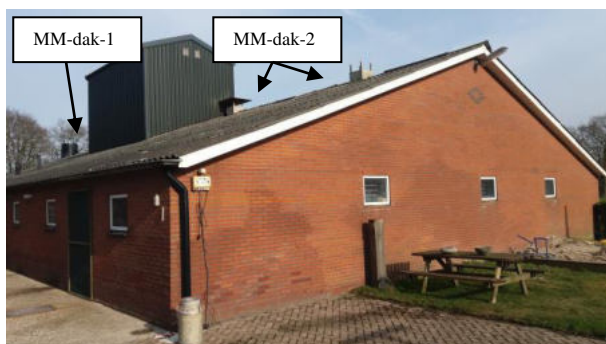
Geïntervieweerde kalverstal met asbesthoudende golfplaat als dakbedekking vanuit zuidwestelijke richting gezien. Tevens asbesthoudend plaatmateriaal aan ventilatiekokers zichtbaar.
